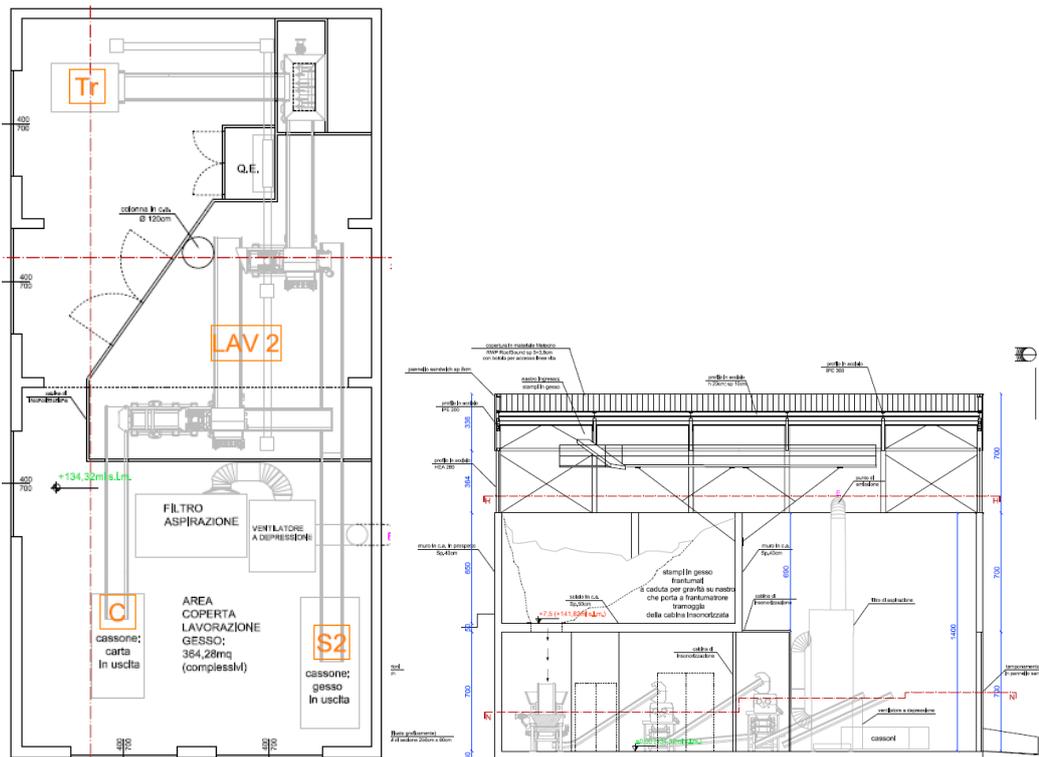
estratto da tavola S9 003_19 PAUR_Tav 04 R1_st prog plan A dim urb prosp_pe.
